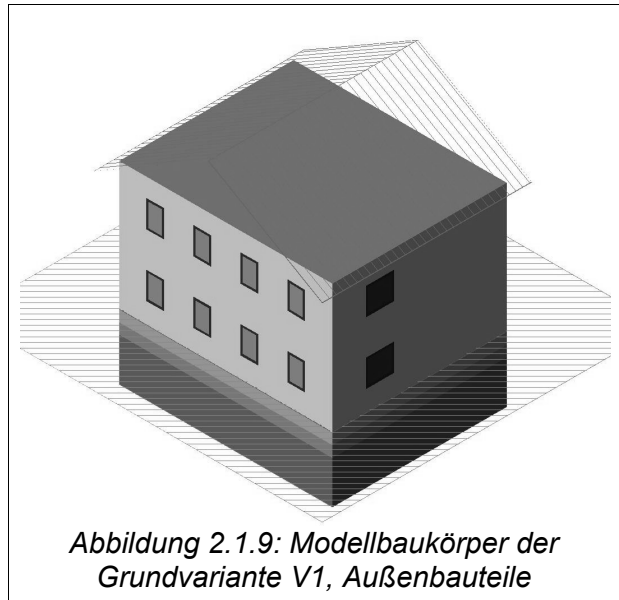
Modellbaukörper der Grundvariante V1, Außenbauteile
